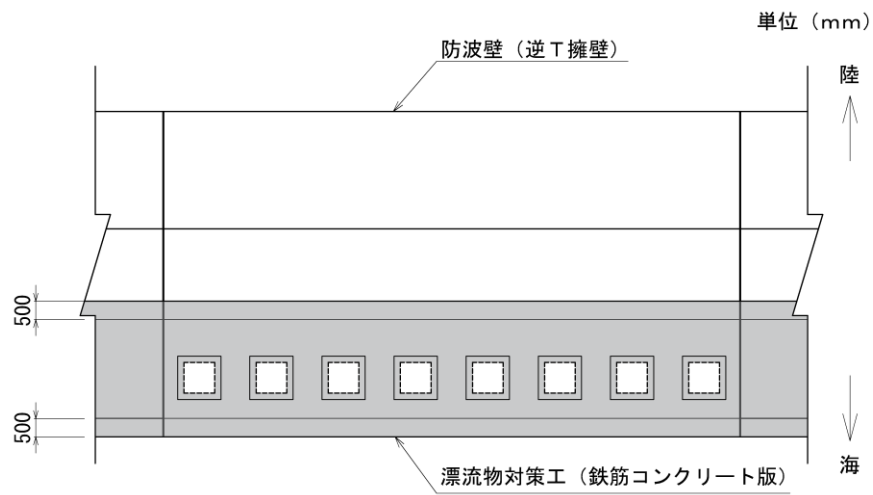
(1) 漂流物対策工 (鉄筋コンクリート版) の構造概要図 (平面図)
